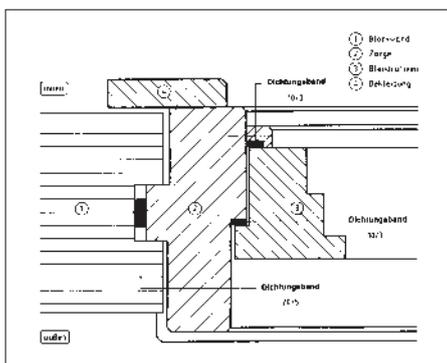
Fensteranschluß an eine Blockhauswand – Horizontalschnitt
